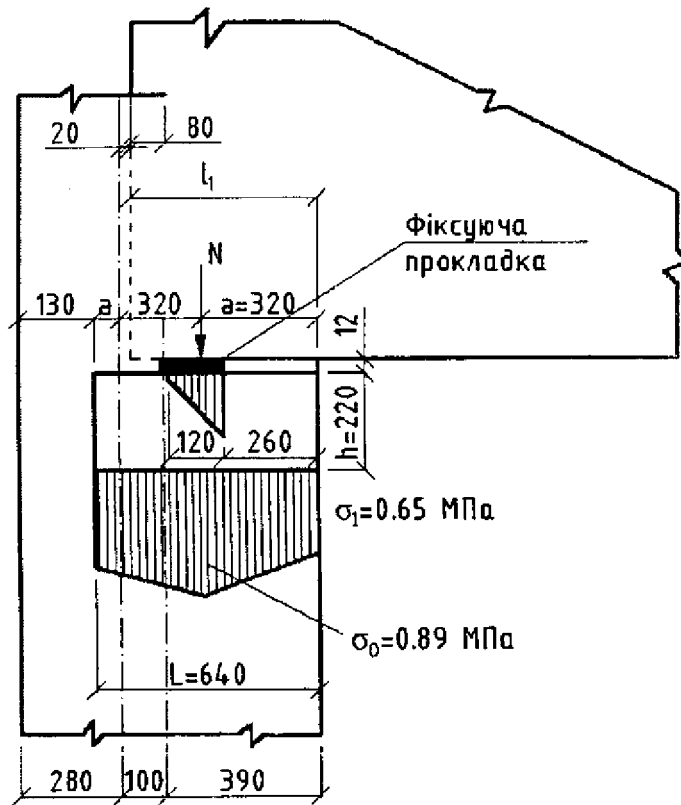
Схема вузла опирання балки на стіну під опорною плитою в напрямку осі балки
